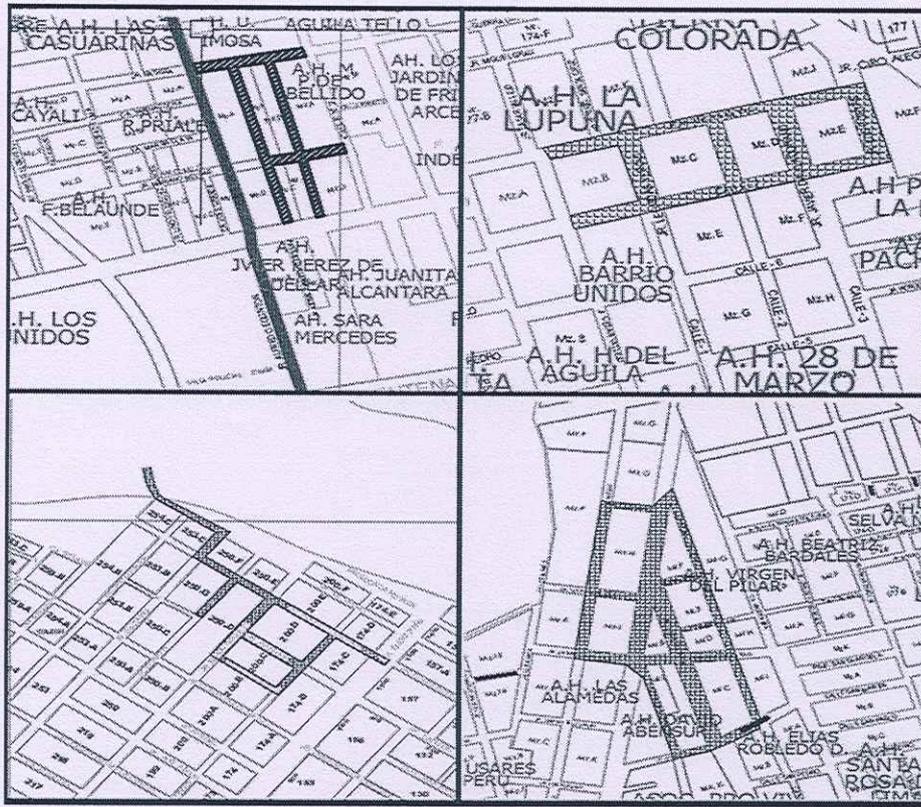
Ubicación para el levantamiento de buzones de alcantarillado
